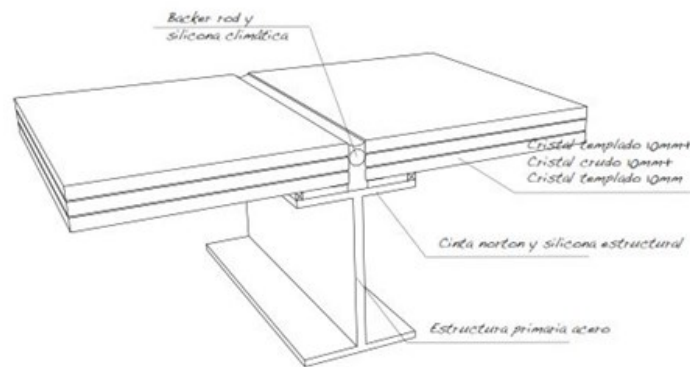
Piso vidriado en plaza central para dar iluminación a espacio intermedio, así como muros bajos para dar ventilación al espacio.
